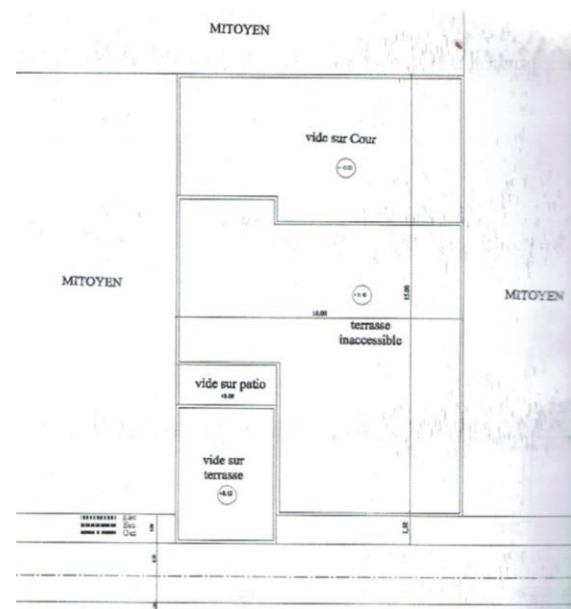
Plan de masse d'une habitation individuelle, Hai Yasmine. Source : DUAC d'Oran
